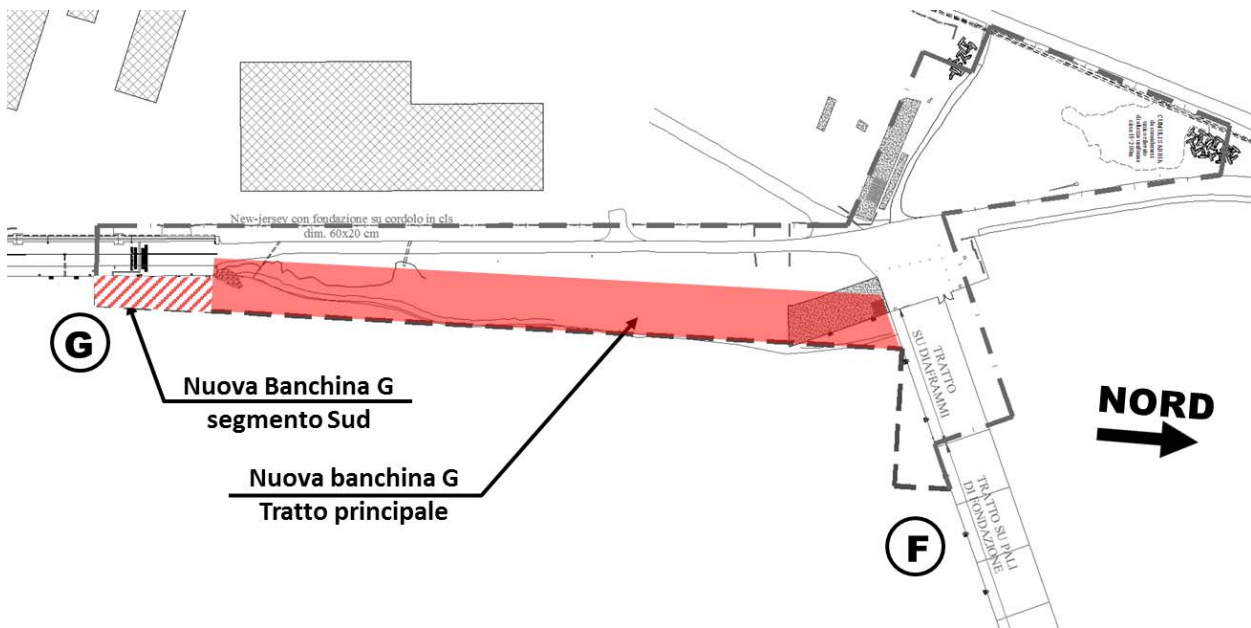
Planimetria schematica delle nuove opere nel tratto G
